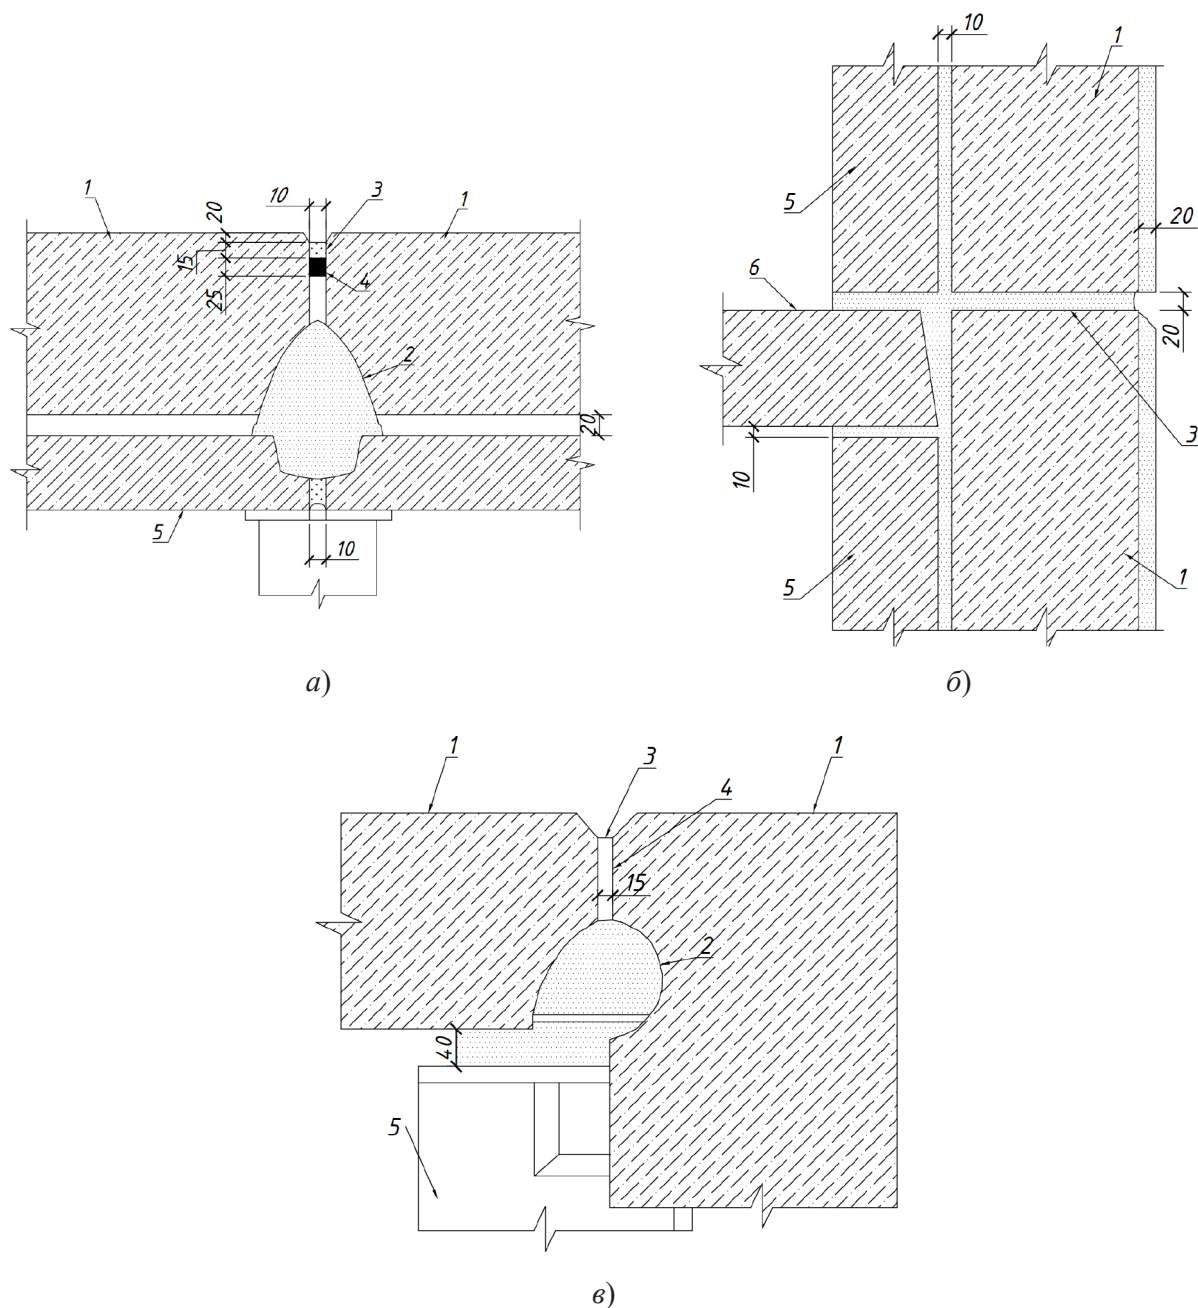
Стыки между наружными стеновыми панелями серии Г-2:
